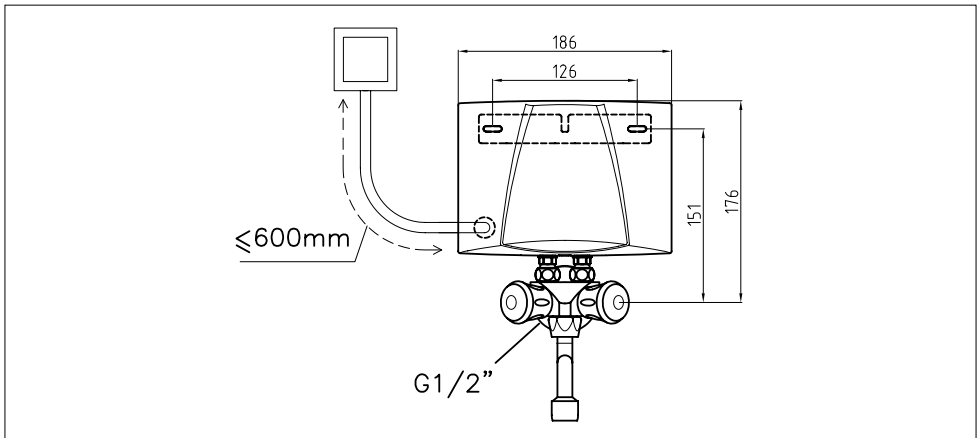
»Installationskizze mit Armatur SMB« (Maßangaben in mm)
